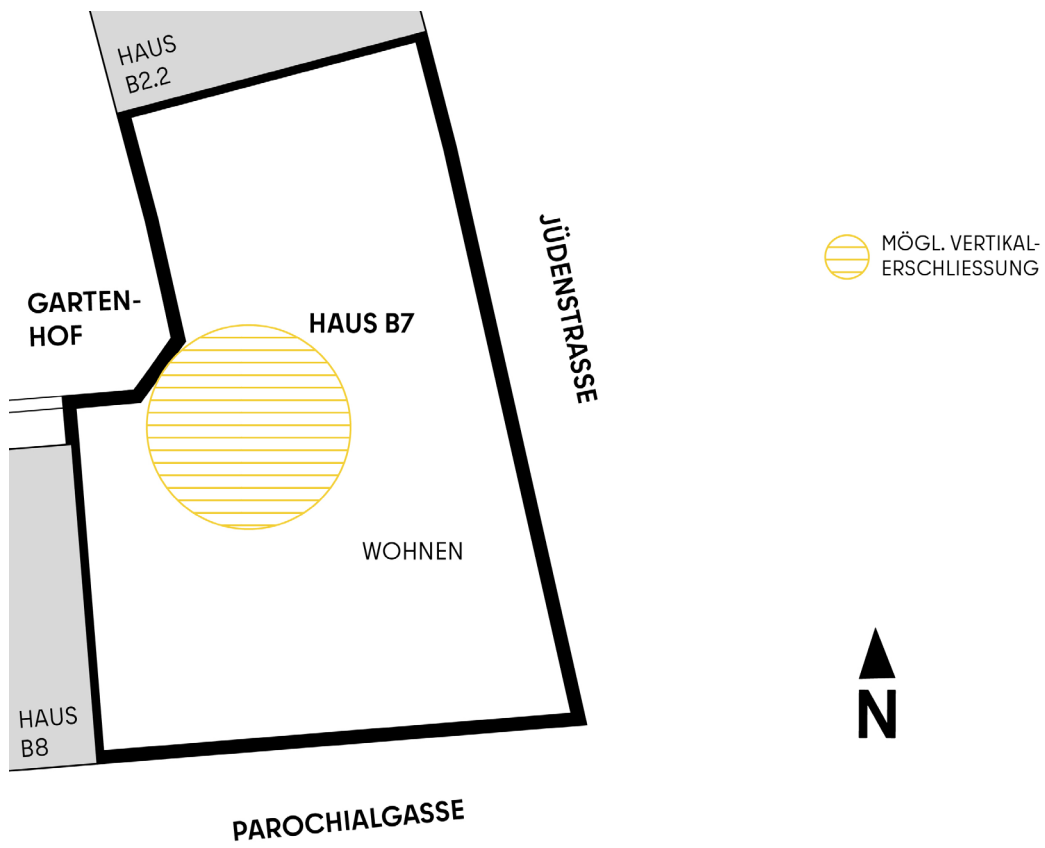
Schematischer Grundriss Regelgeschoss
